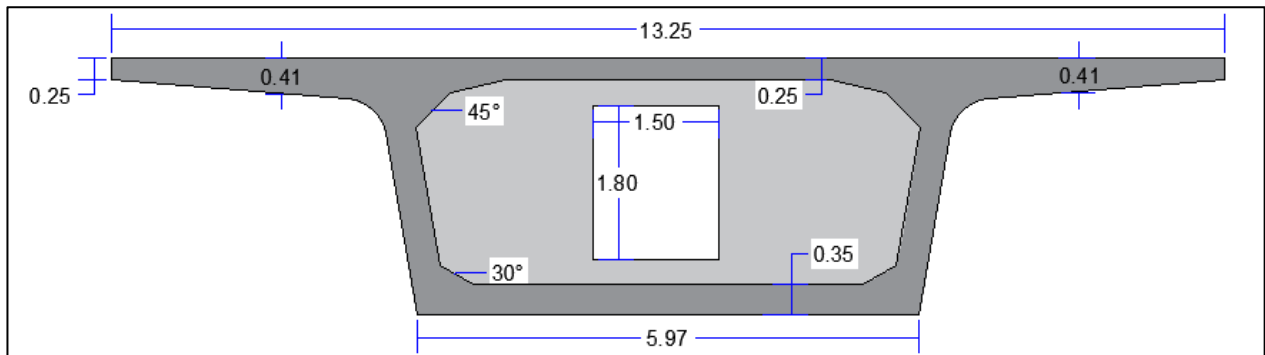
Les dimensions des voussoirs sur pile VARIANTE 02
